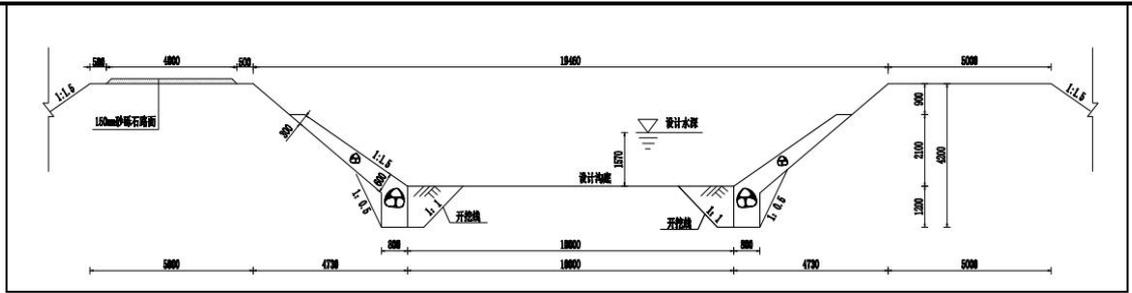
桩号 K7+600-K8+400 段砌护横断面图
